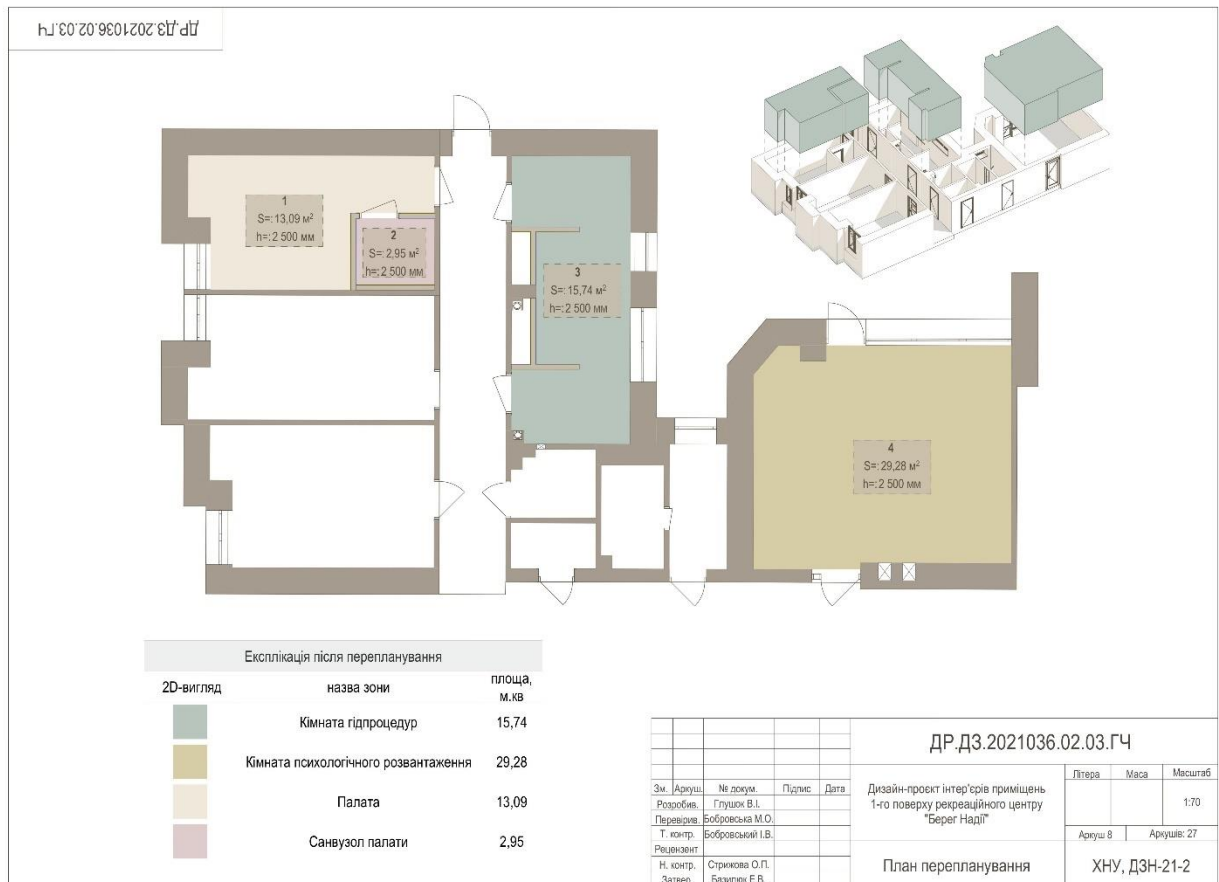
План після перепланувань кімнат першого поверху
